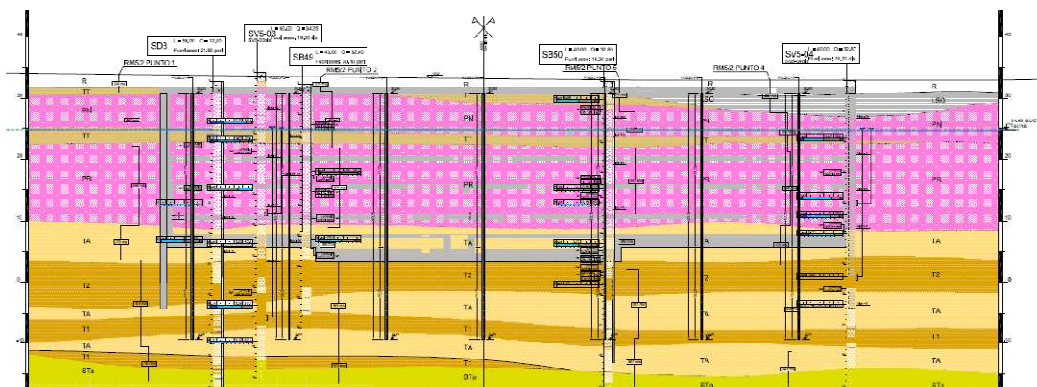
Stazione Gardenie: Pozzi – Sezione stratigrafica longitudinale
